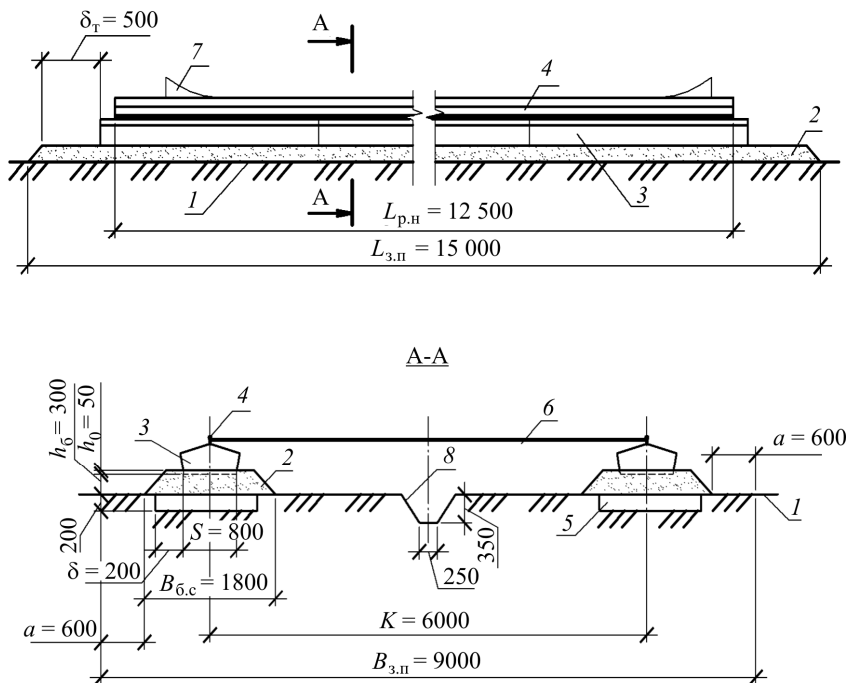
Пример устройства подкрановых путей башенного крана на жестком основании из железобетонных плит: 1 – земляное полотно; 2 – балластный слой; 3 – железобетонная балка; 4 – рельс; 5 – железобетонная плита; 6 – стяжка; 7 – упор тупиковый безударного типа; 8 – водосборная канава; K – колея крана; $B_{3.n}$ – ширина земляного полотна; $B_{6.c}$ – ширина балластного слоя; S – размер опорных элементов (поперек оси пути); δ – боковое плечо балластного слоя; δ_T – торцевое плечо балластного слоя; h_6 – толщина балластного слоя; h_0 – толщина слоя подсыпки балласта; $L_{p.n}$ – длина рельсовой нити; $L_{3.n}$ – длина земляного полотна
